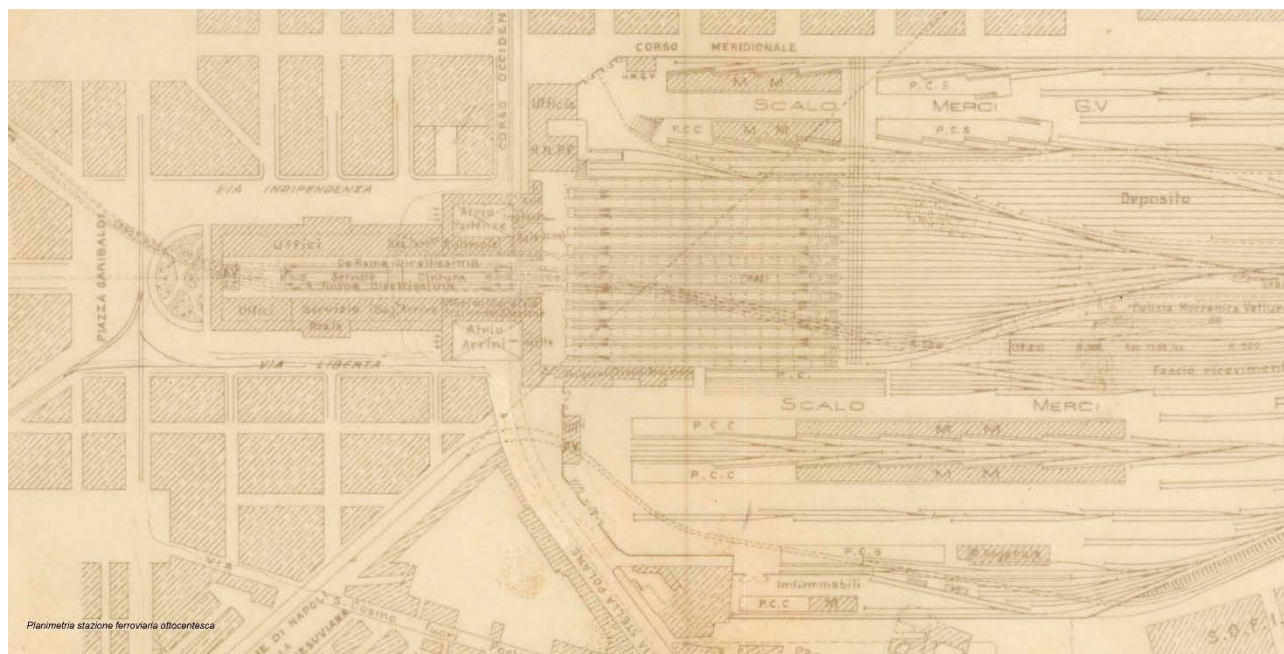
Planimetria della stazione di Napoli Centrale e Scali Merci (1867 ca)
